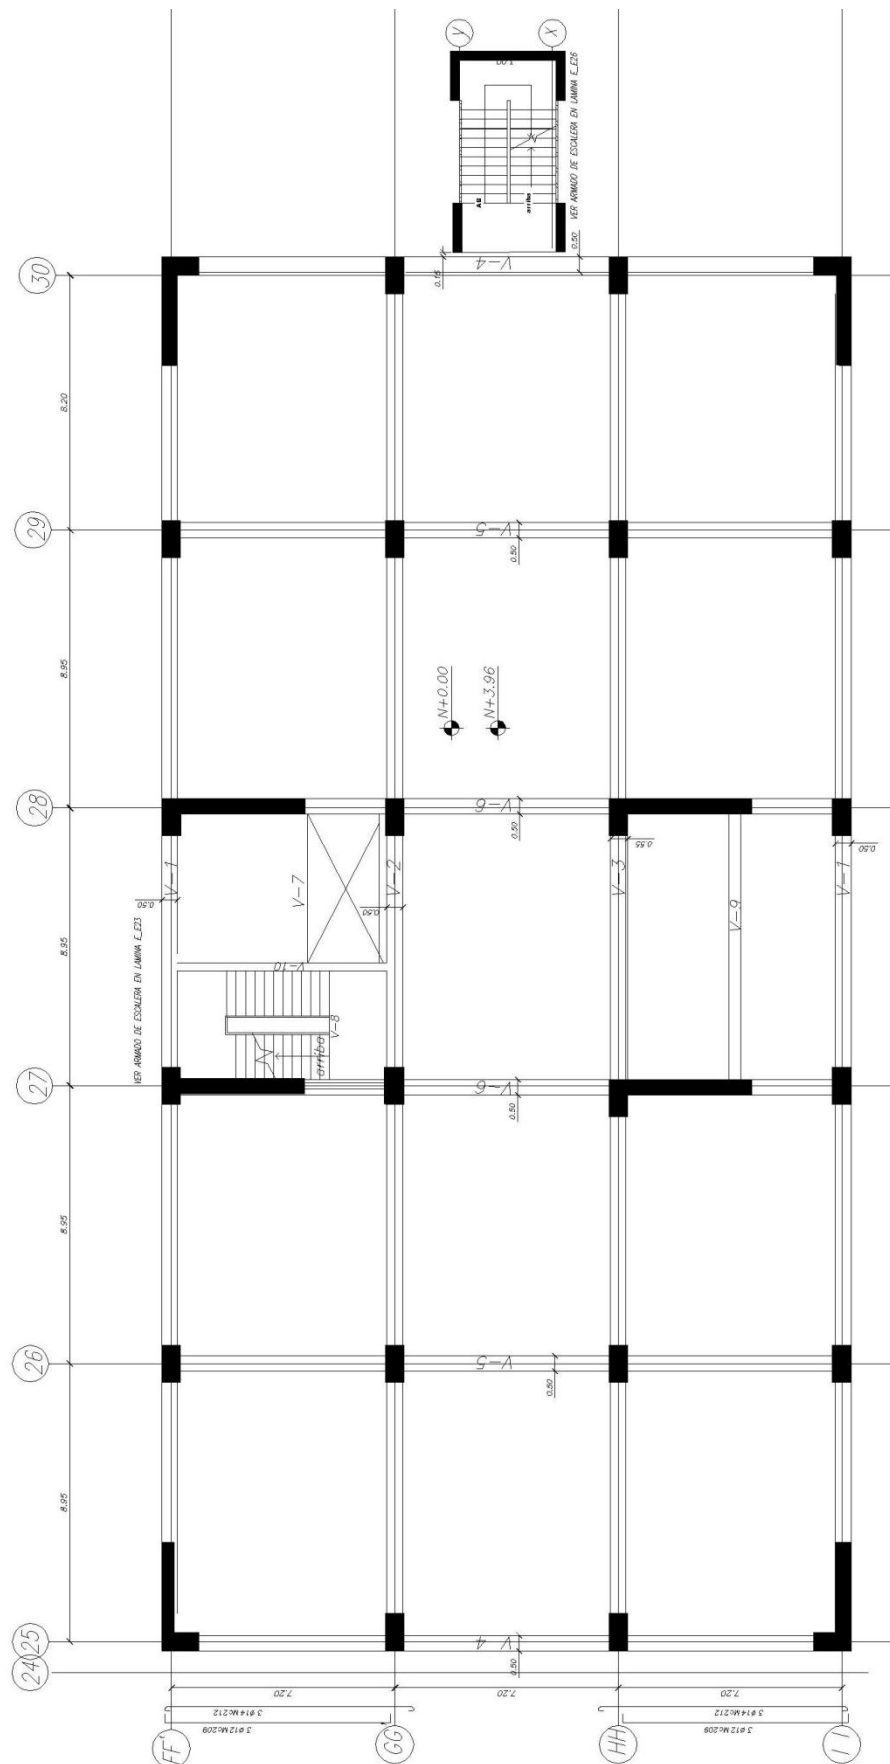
Planta Estructural Nivel: -3.96m HOSPITALIZACION
